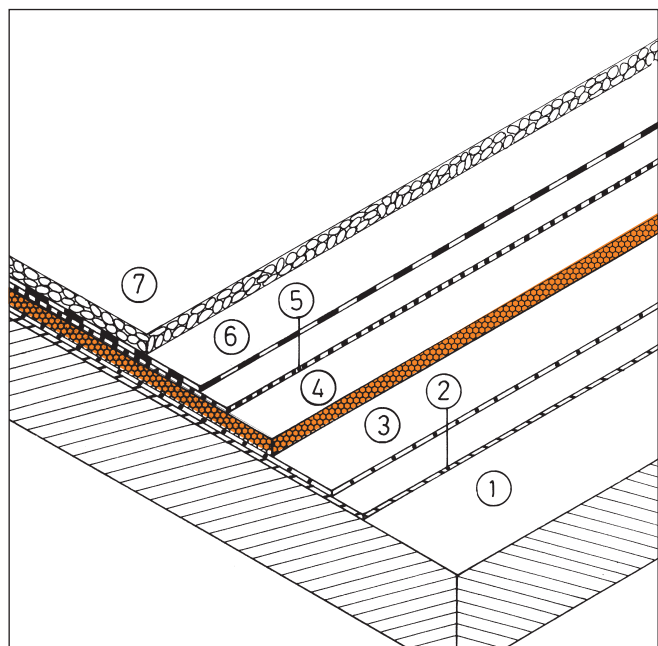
Isolamento sotto impermeabilizzazione di tetto piano.
